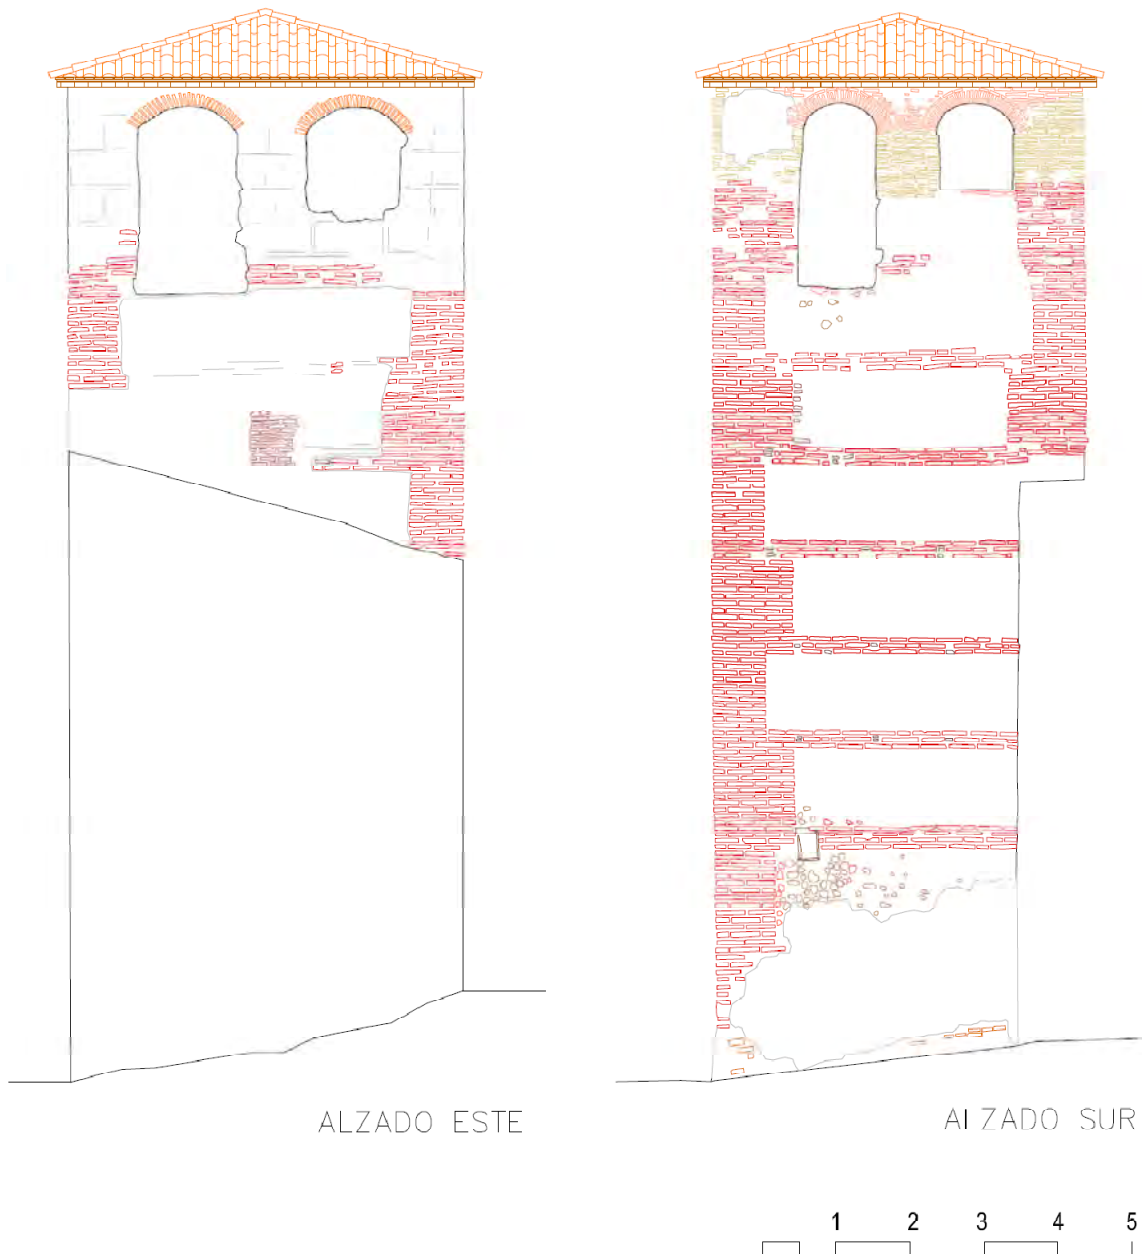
alzados este y sur del estado actual de la torre de San Cristóbal de Trabancos. El dibujo del alzado este destaca el esgrafiado en la zona del campanario. En el alzado sur son visibles los machones verticales que se apoyan sobre la fábrica medieval.
